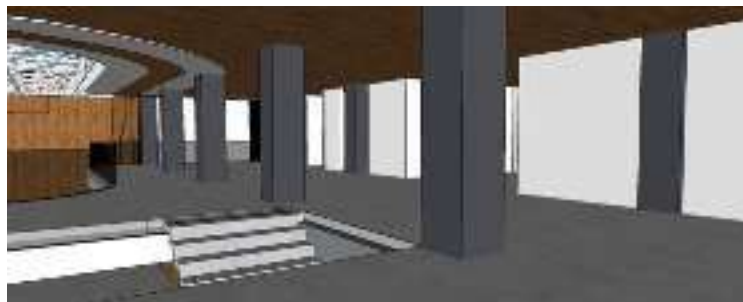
Konsep Struktur (Pondasi Tiang Pancang)
